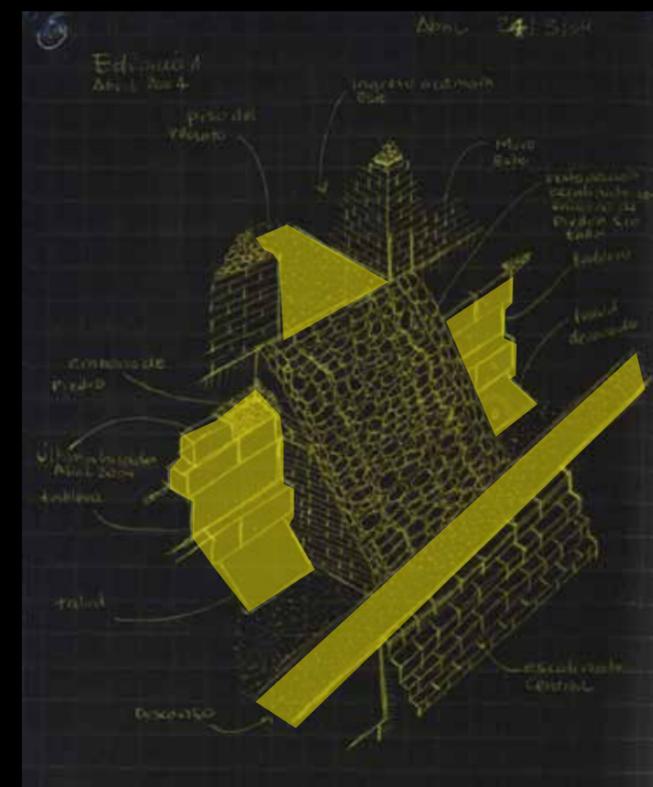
Dibujo Edificio 1 Fachada Este, detalle técnico de restauración en el basamento de la cámara superior. Reintegración de fachada de piedra del tablero. Dibujo: GAMH 2002
